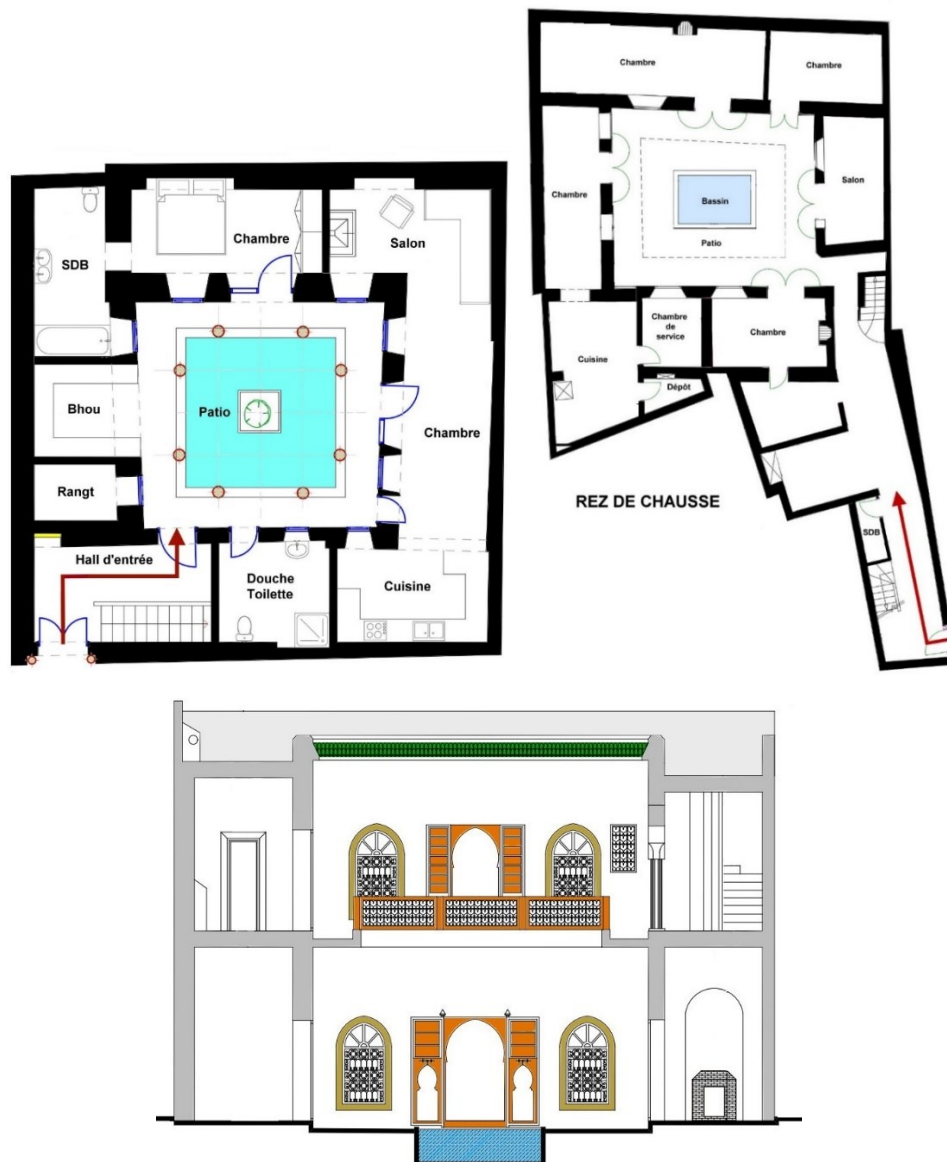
Plan typique d'un riad traditionnel montrant les façades sur la cours centrale.
